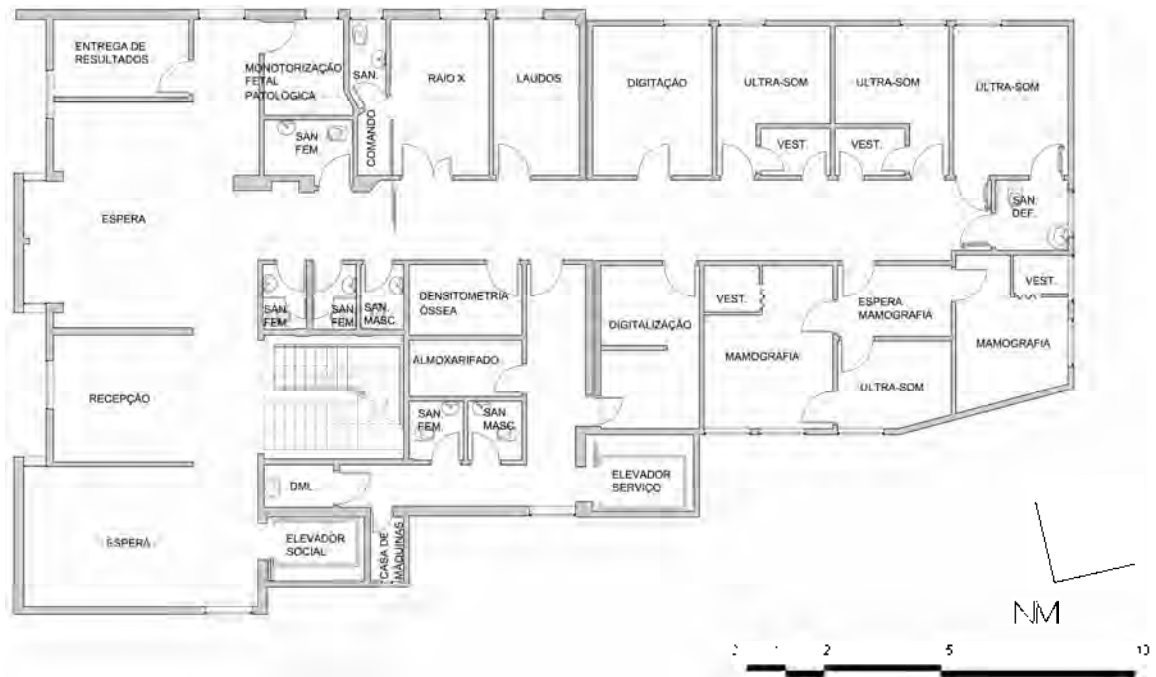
Planta – segundo pavimento conforme zoneamento Z13.
